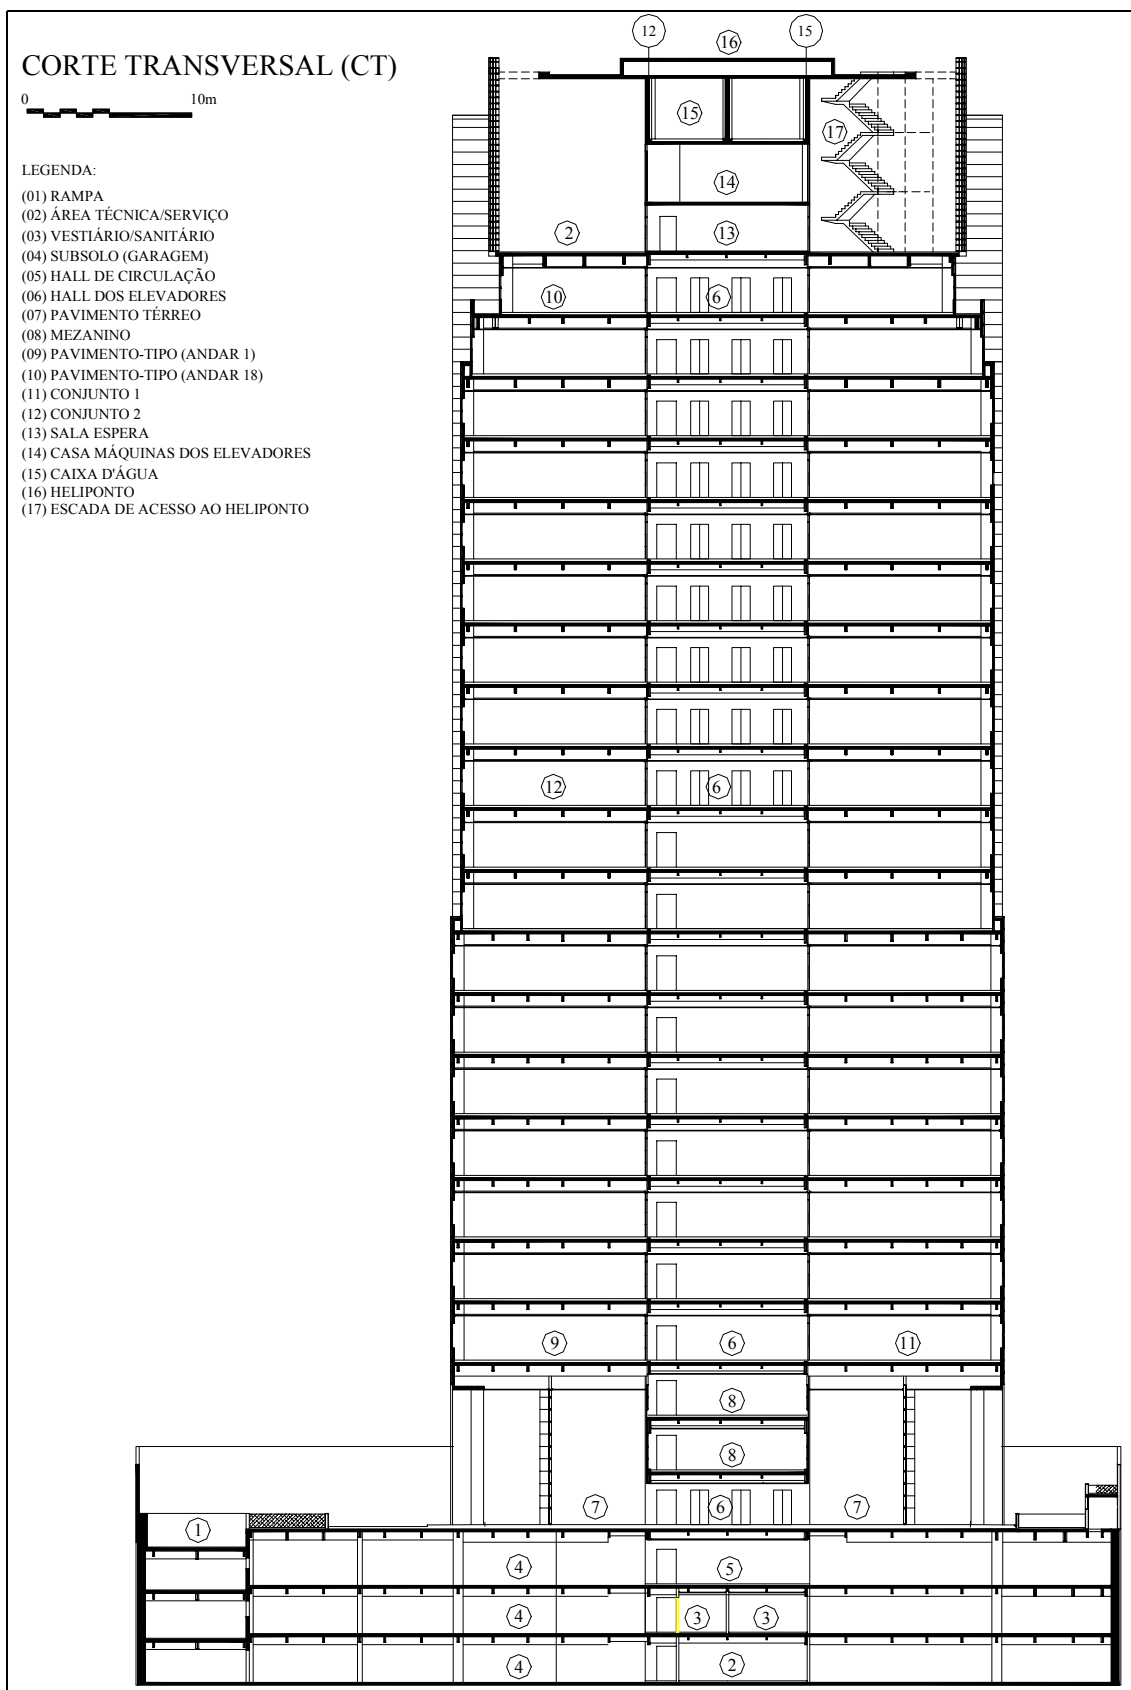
Solução arquitetônica do E-2: esboço do corte transversal.
